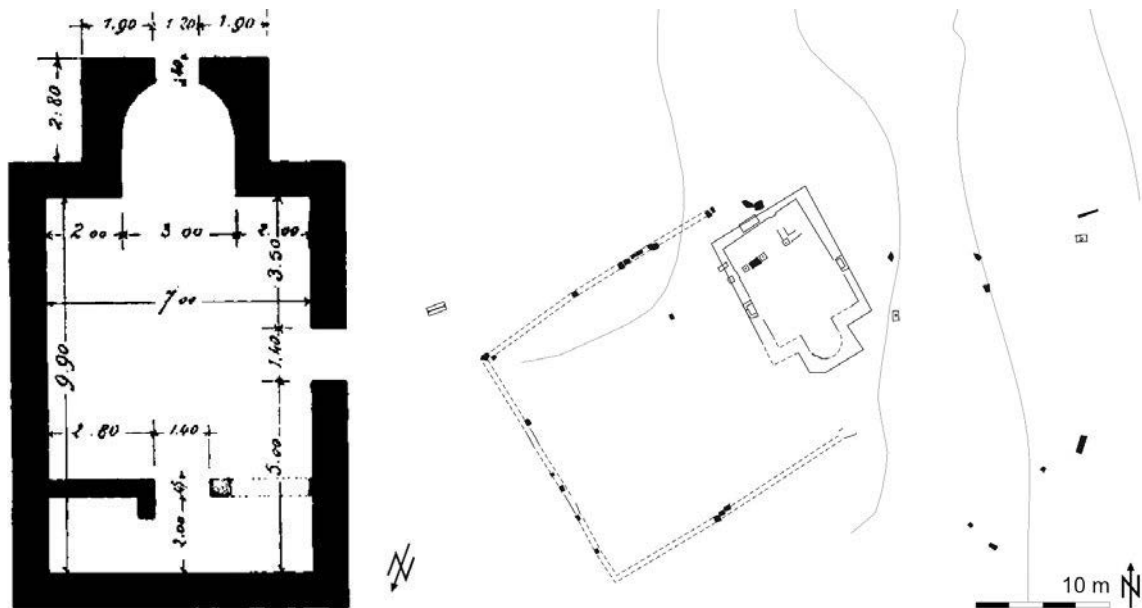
Henchir Oued Soussa/Ain Azouza. Plan der Kirche
